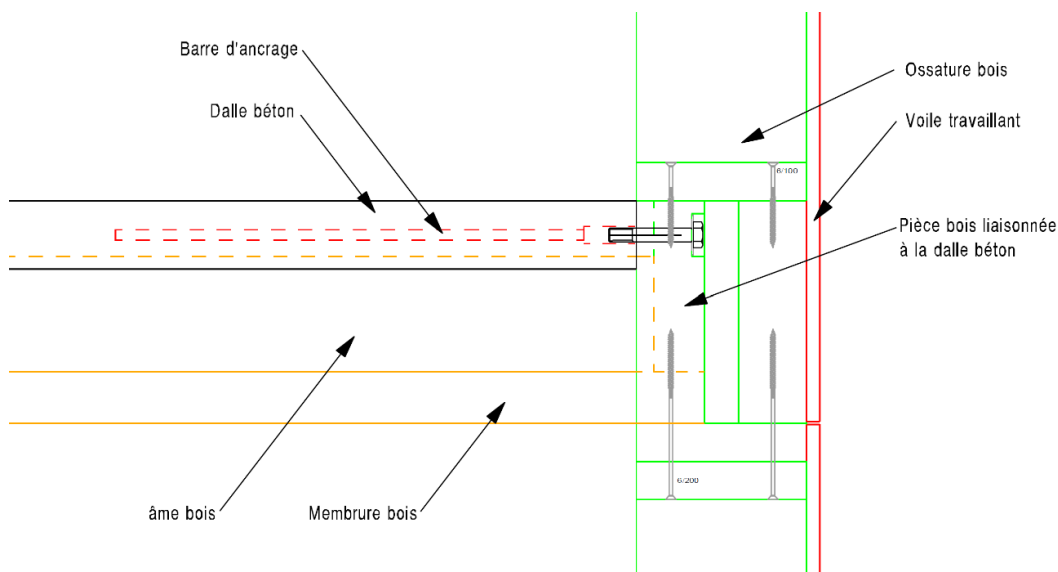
Détail de la liaison d'un élément de plancher à un mur ossature bois
